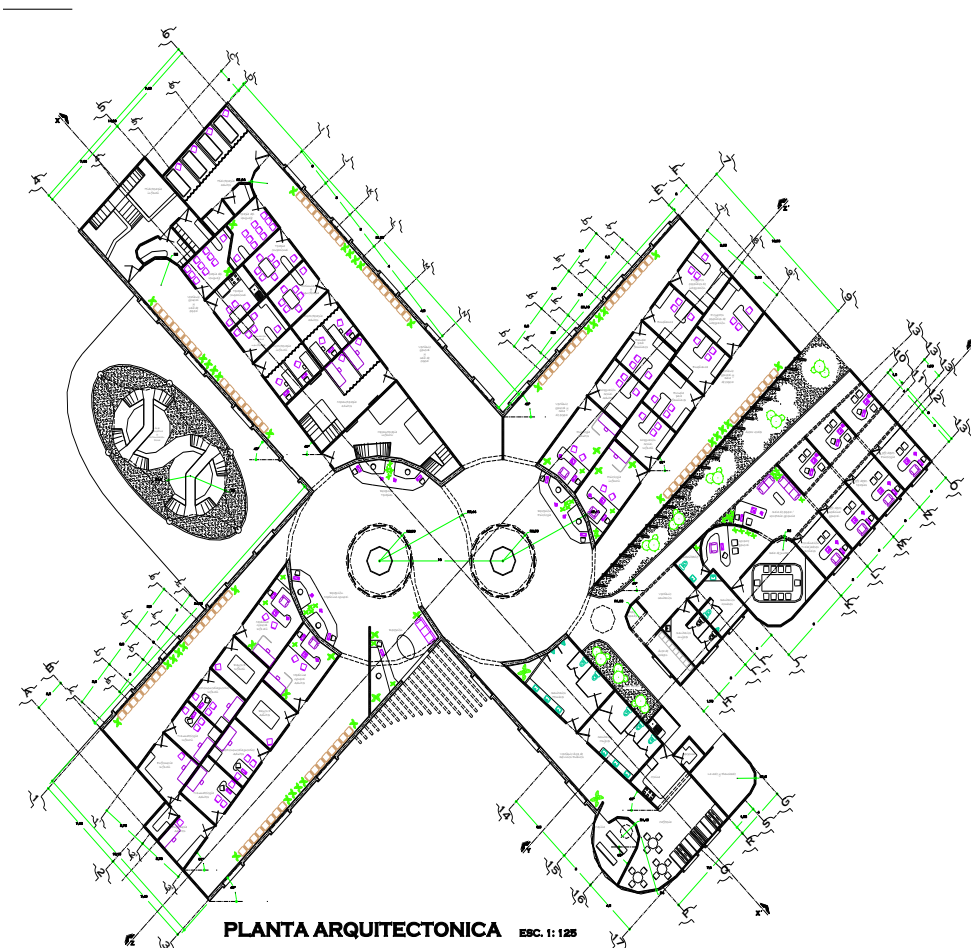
Planta Arquitectónica Centro de Rehabilitación.
